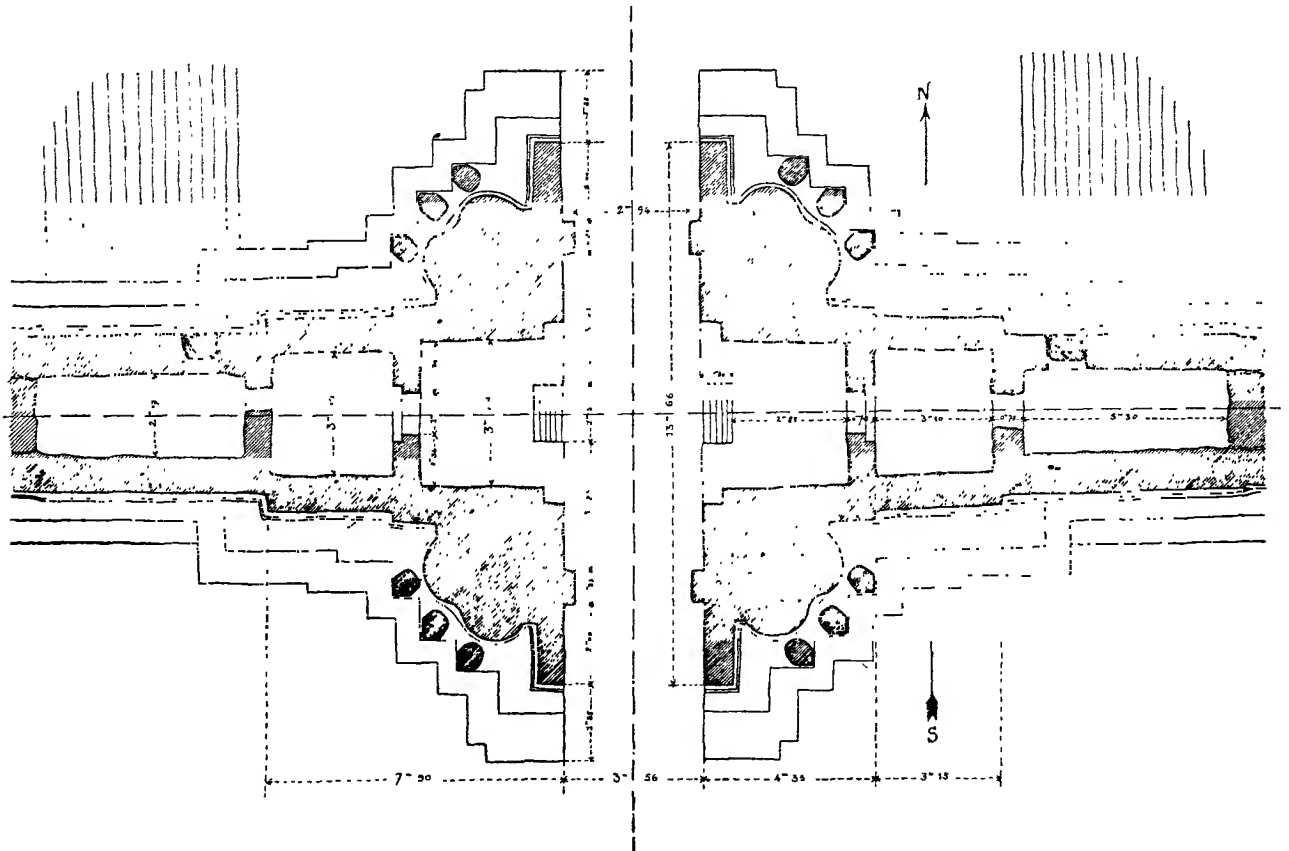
Plan de la porte Sud d'Angkor Thom.
